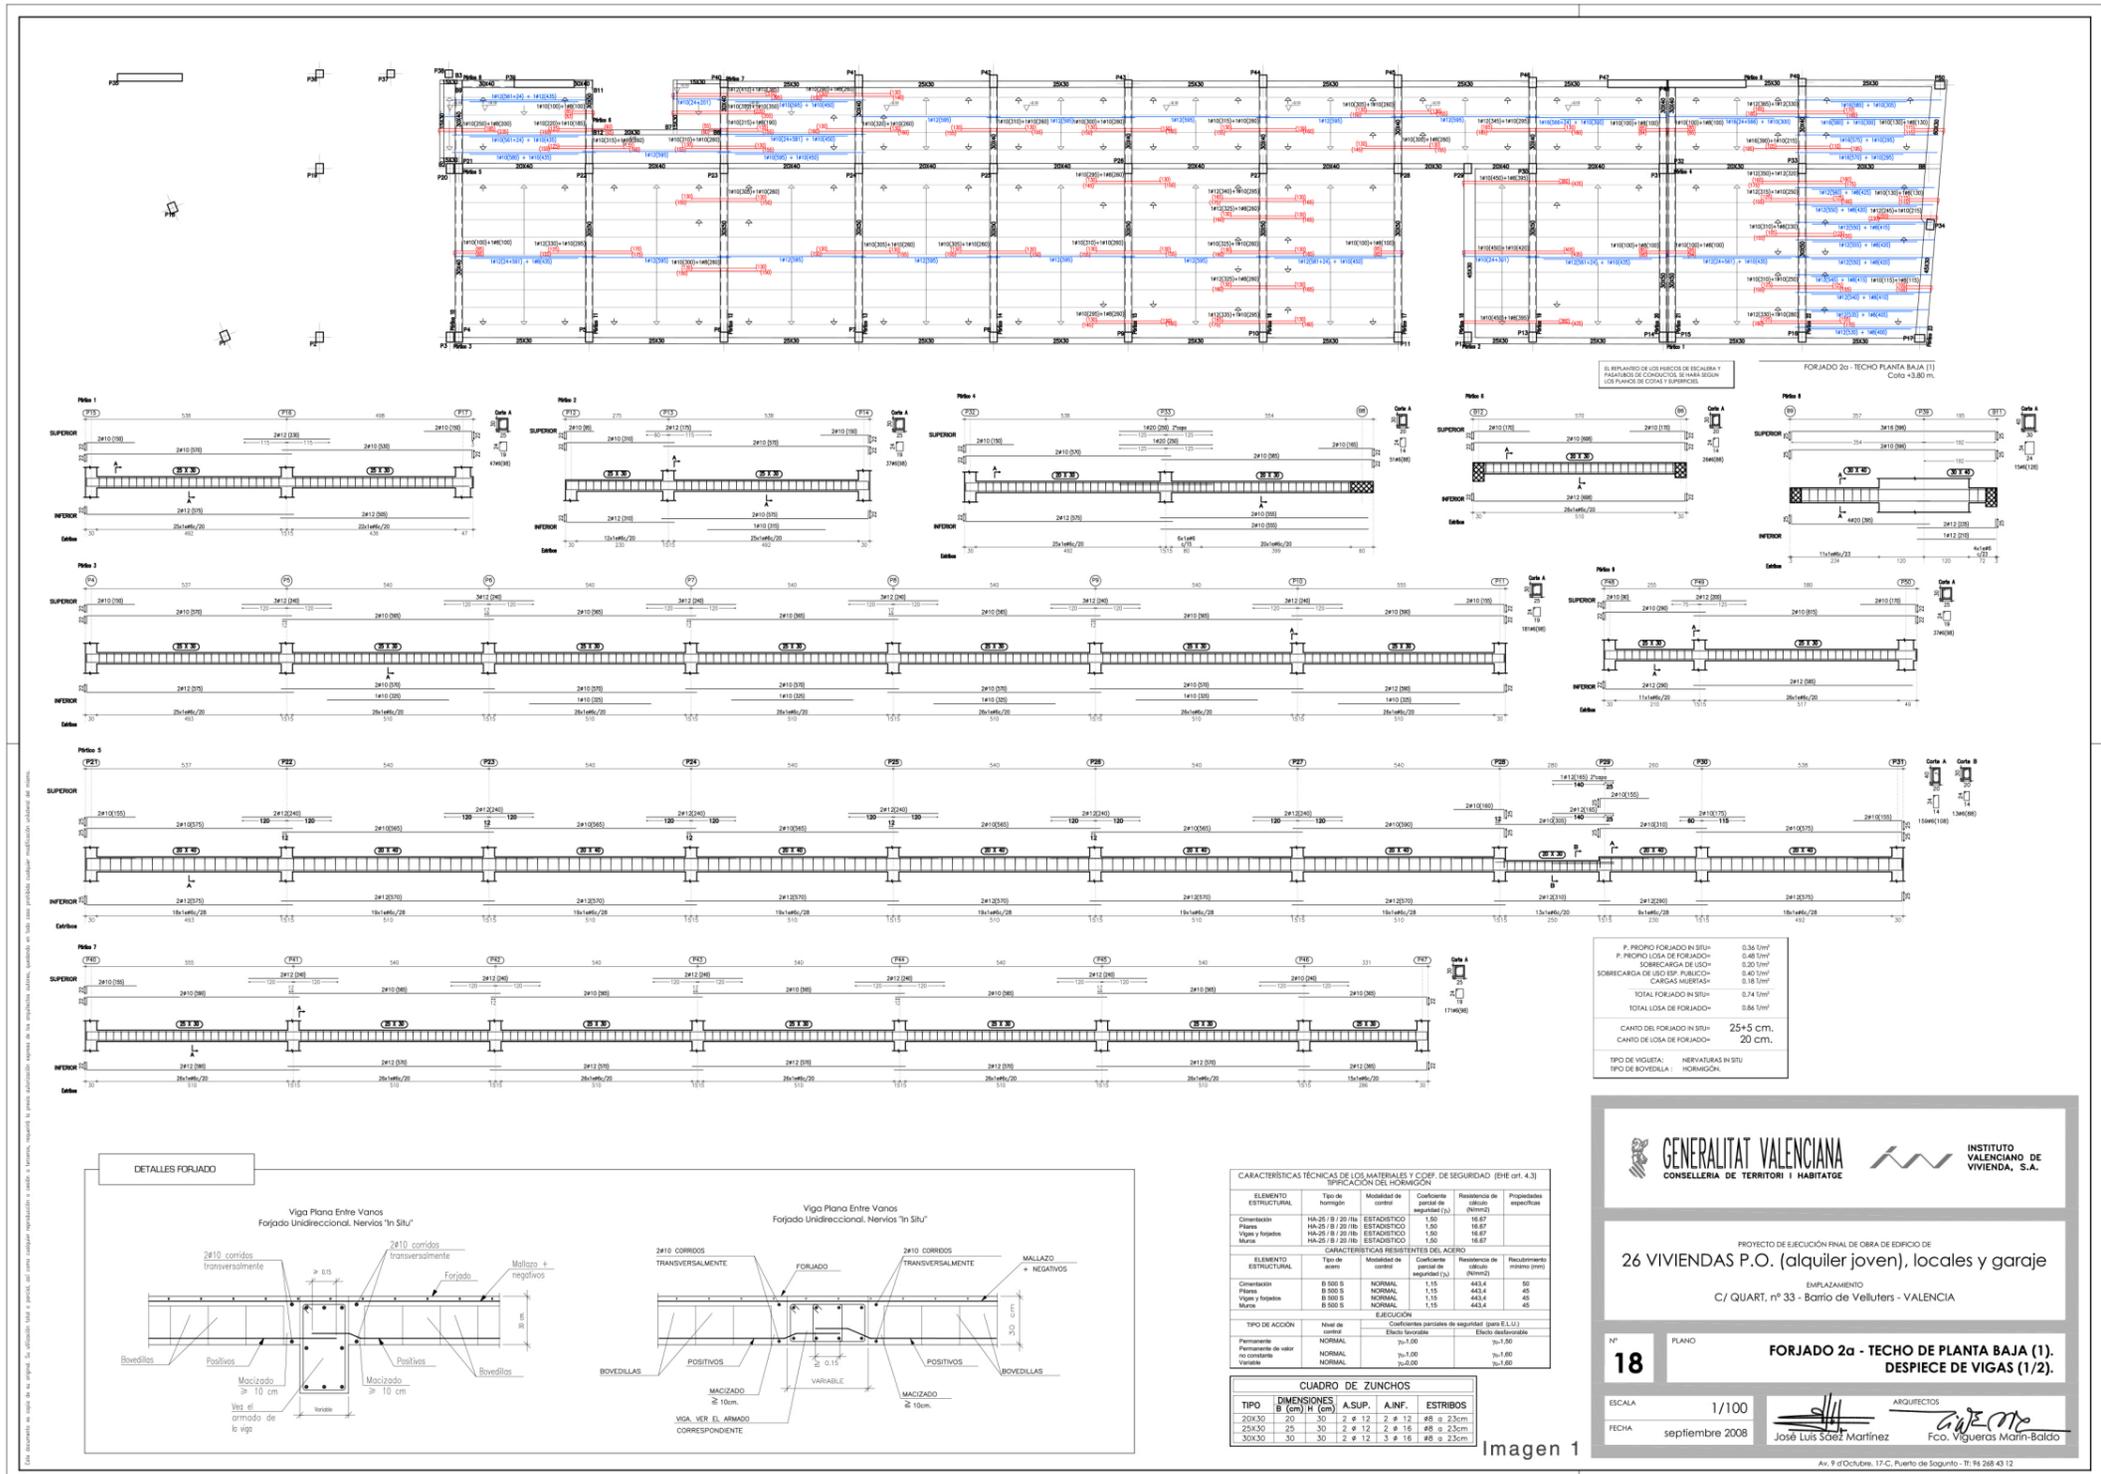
Planta y detalles constructivos de forjado. Documentación aportada por Sáez + Vigueras arquitectos.
